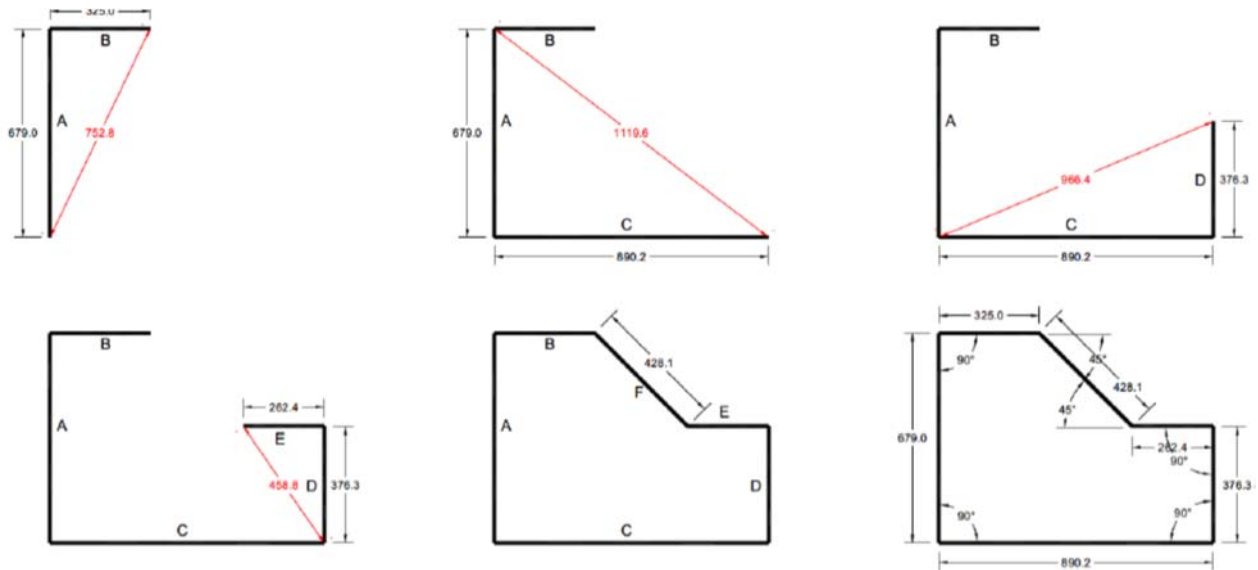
Tracciamento planimetrico suddividendo la planimetria in triangoli e definizione delle diagonali di riferimento
